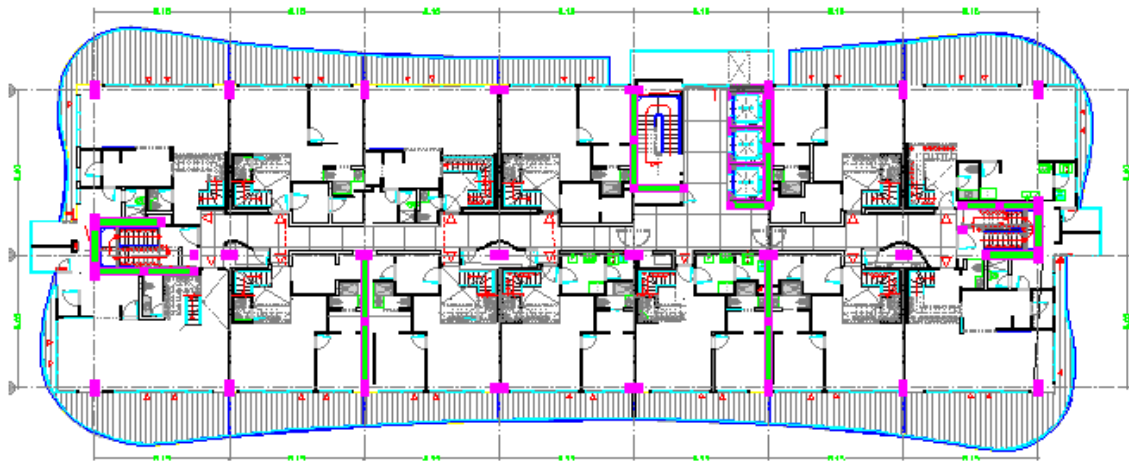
Planta de viviendas, columnas (lila) y arriostramientos (verde).
